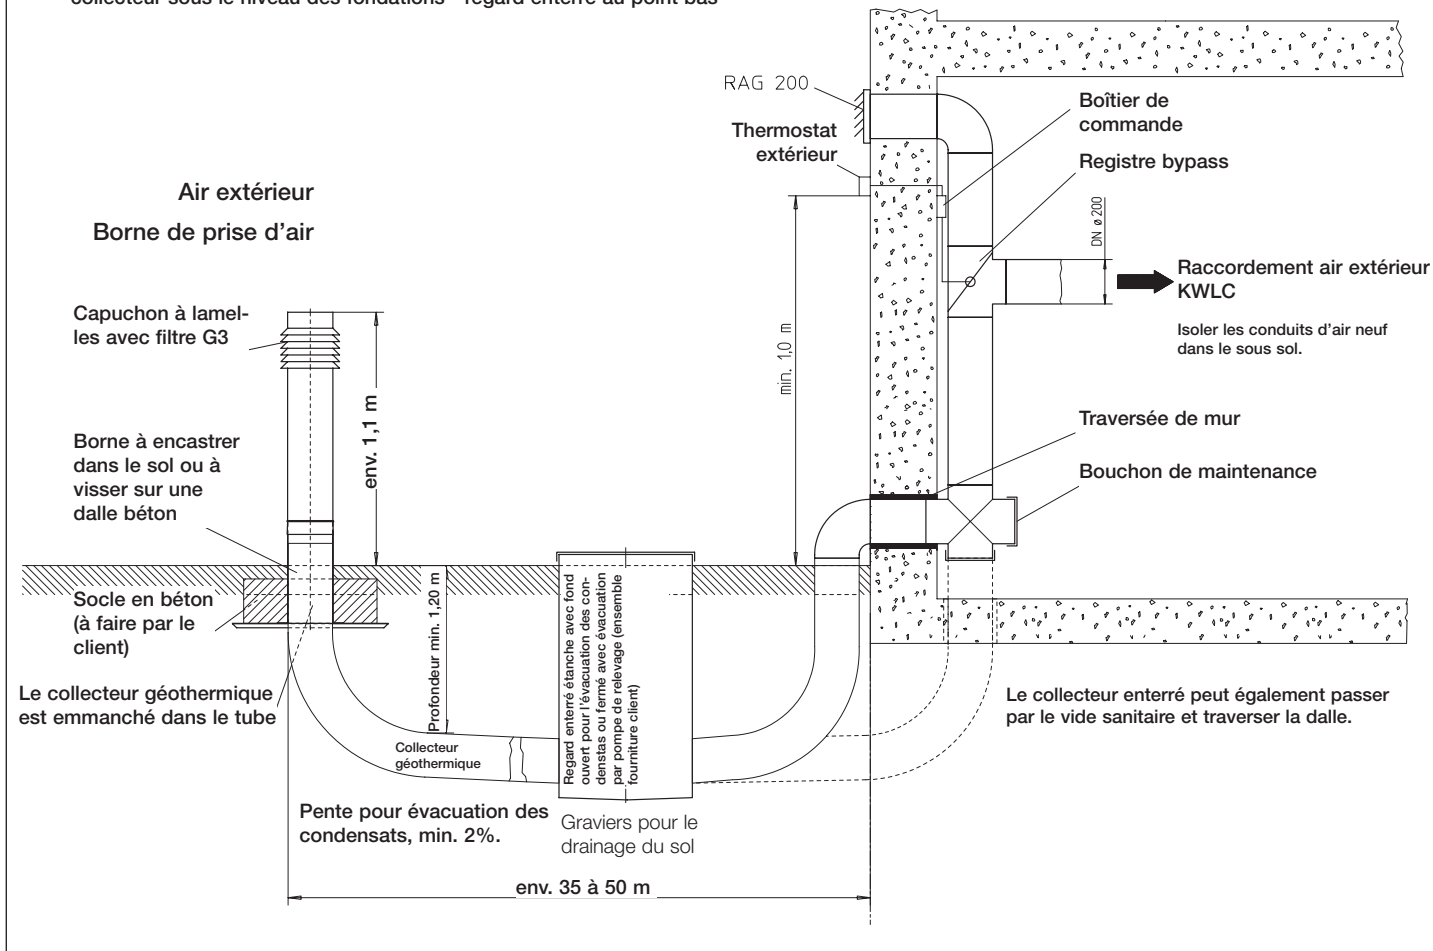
Schéma de principe pour une installation en pavillon sans sous sol enterré, collecteur sous le niveau des fondations - regard enterré au point bas
